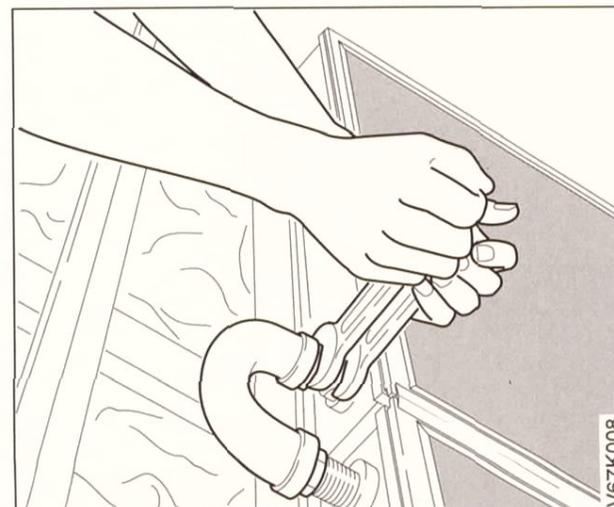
Kollektoren mit Edelstahlwellschläuchen verbinden. Gegenhalten beim Festziehen schützt Kollektoranschluß vor Schäden.
